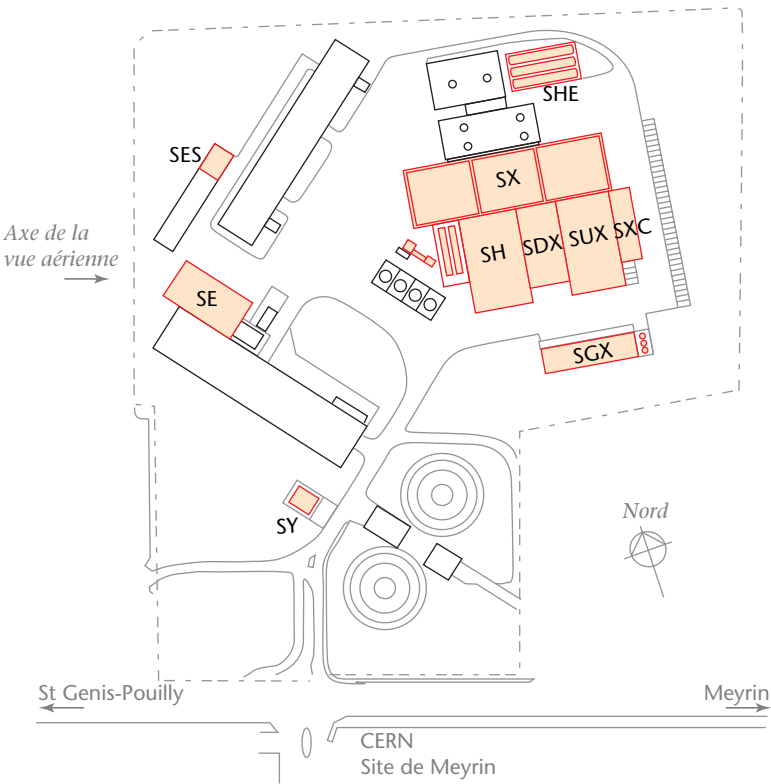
Plan de masse des ouvrages de surface au Point 1
